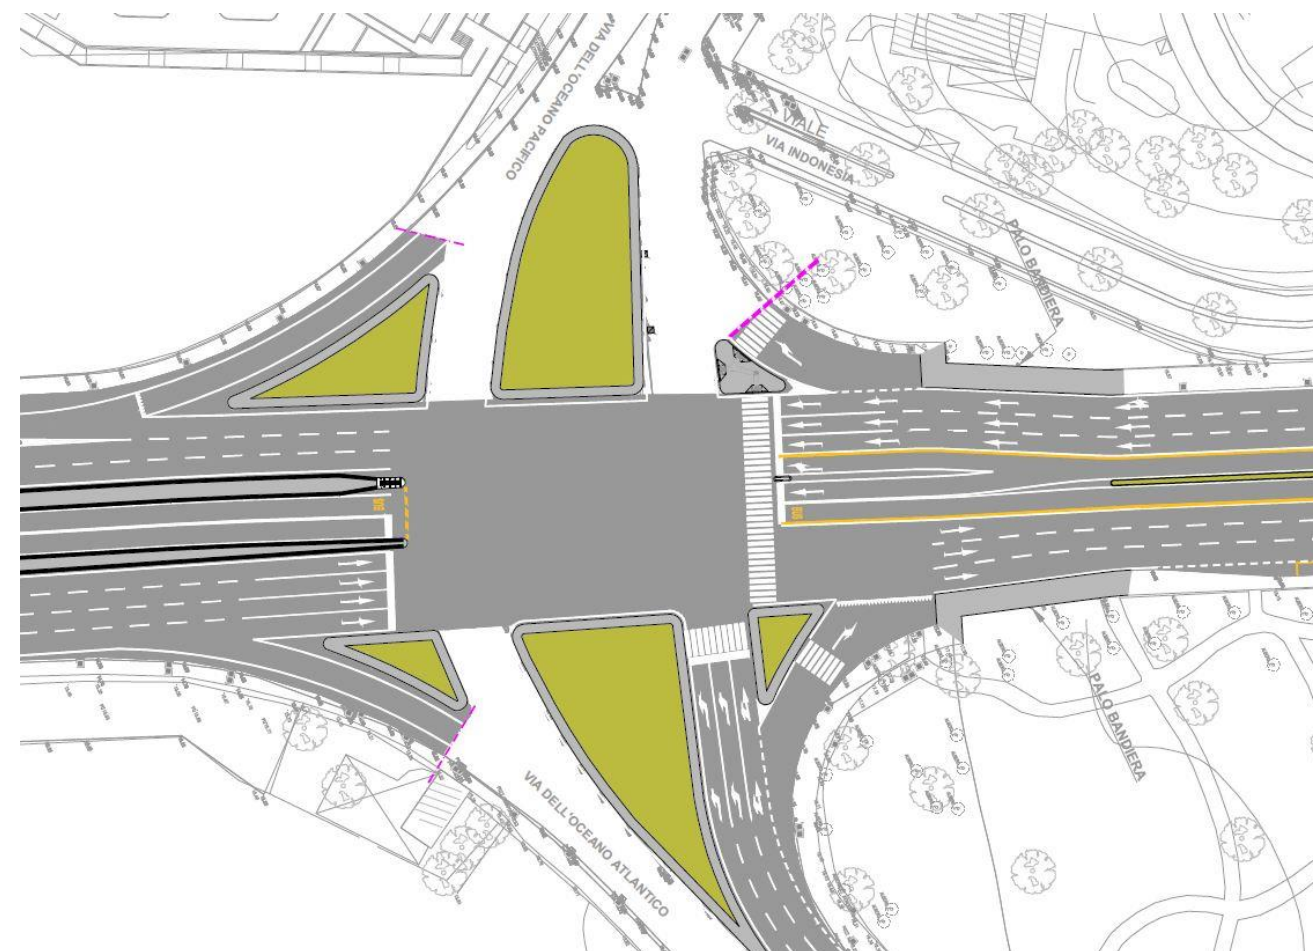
stralcio planimetrico sistemazione piazzale 25 Marzo 1957
